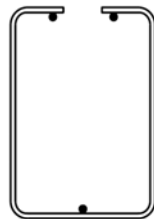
Zulässige Bereiche der Schweißung (hier als Beispiel dargestellt für nicht gestaffelte Bewehrung)
